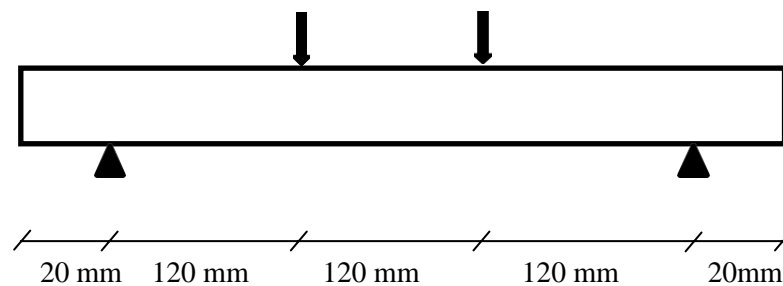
Schéma de flexion 04 points d'une dalle
